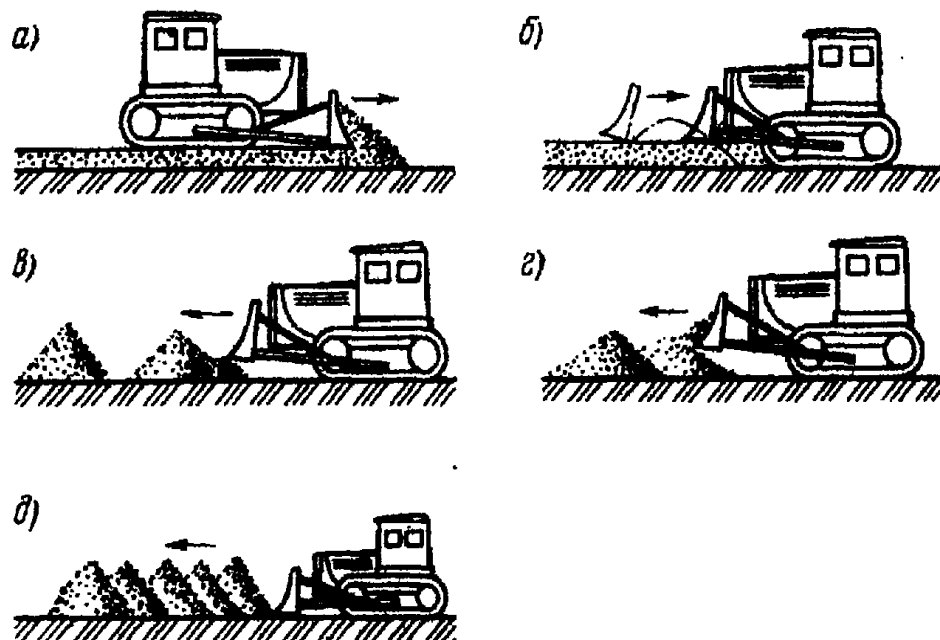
Основні схеми укладки ґрунту бульдозерами
